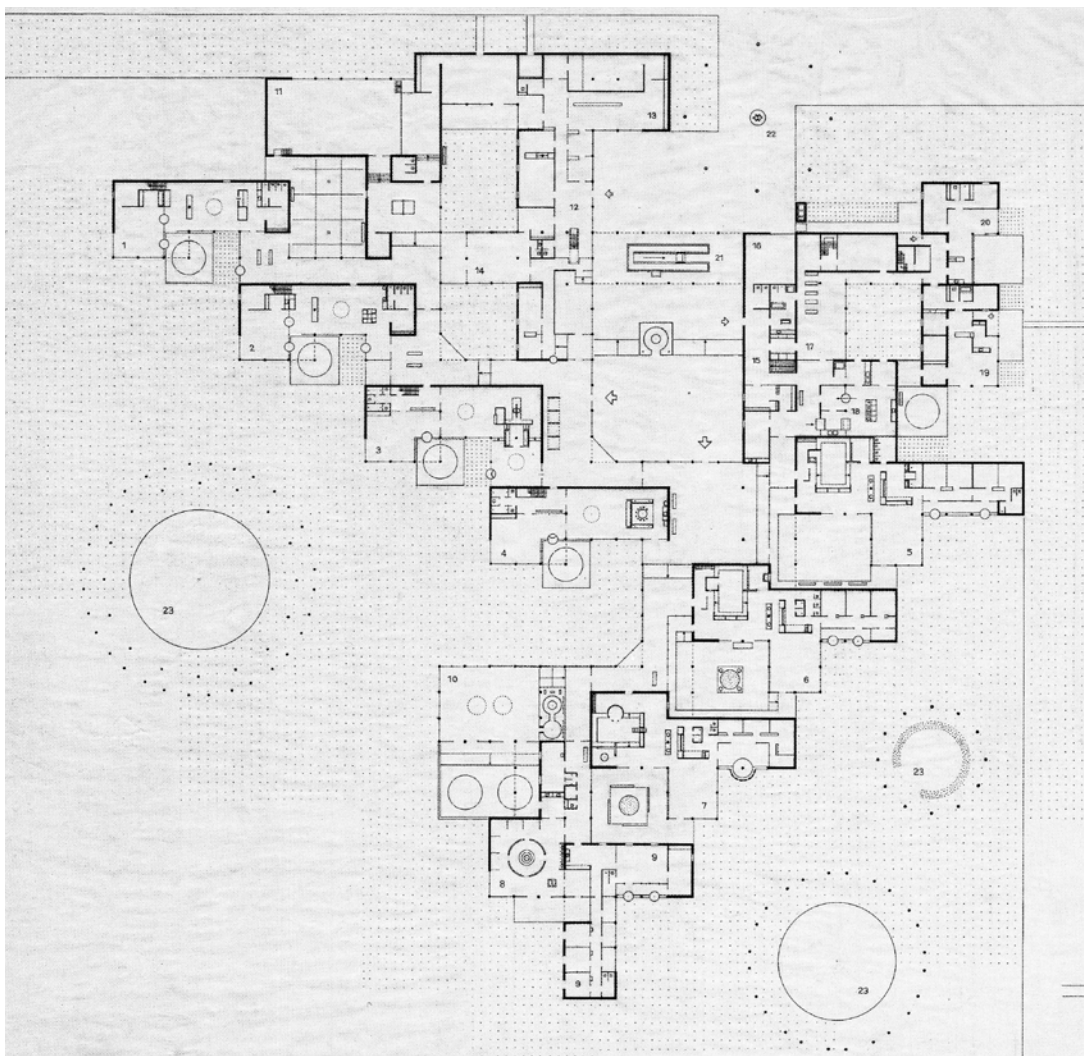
Grundriss Orphanage Amsterdam 1960
